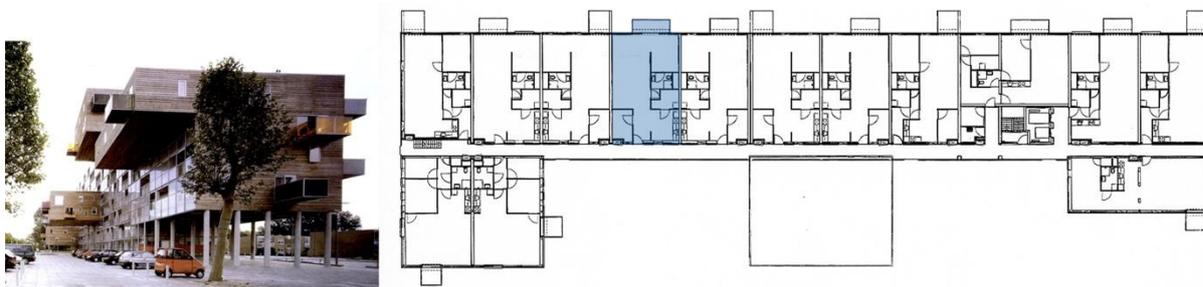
Beispielhafter Grundriss eines Wohngebäudes mit Laubengängerschließung | Wozoco | MVRDV | Amsterdam (NL) | 1997
